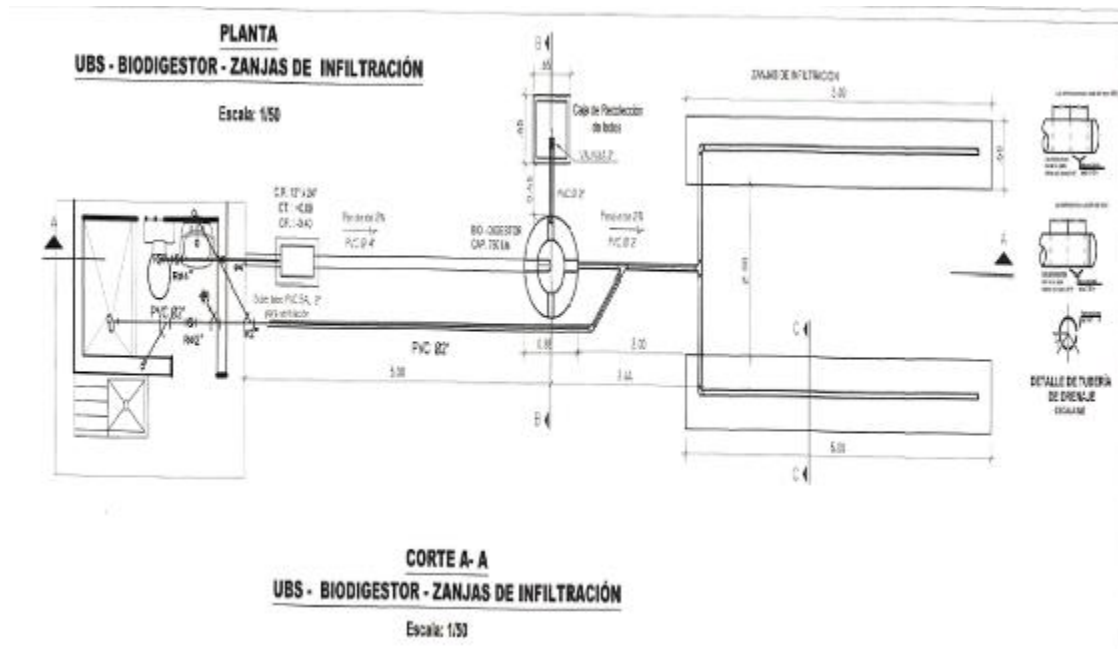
Planta de UBS – Biodigestor – Zanjias de infiltración
